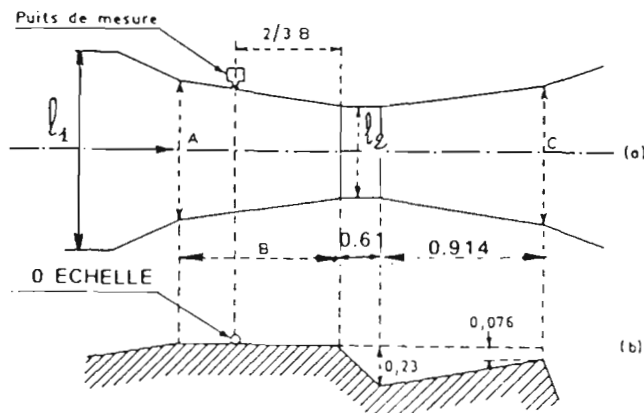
DIMENSIONS USUELLES D'UN PARSHALL (m)
